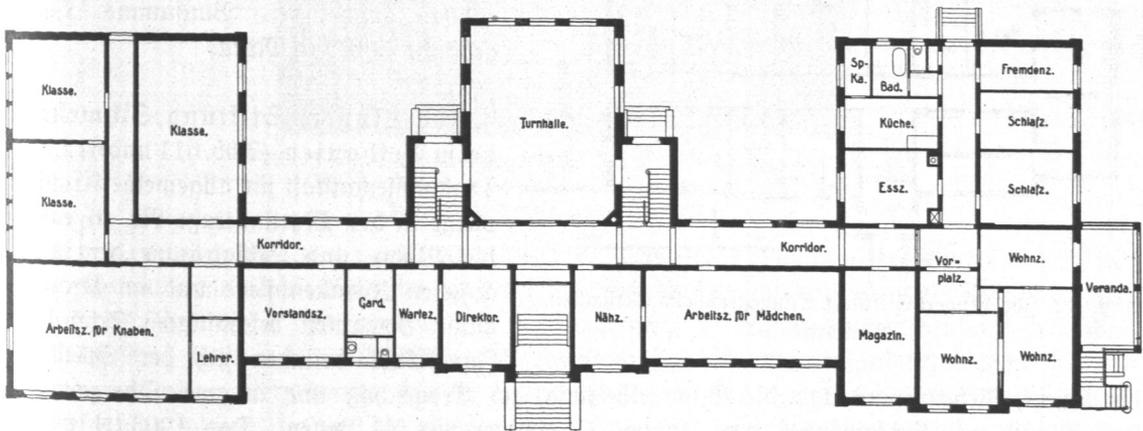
Pestalozzi-Stift in Volksdorf, Erdgeschoß, Grundriß.
